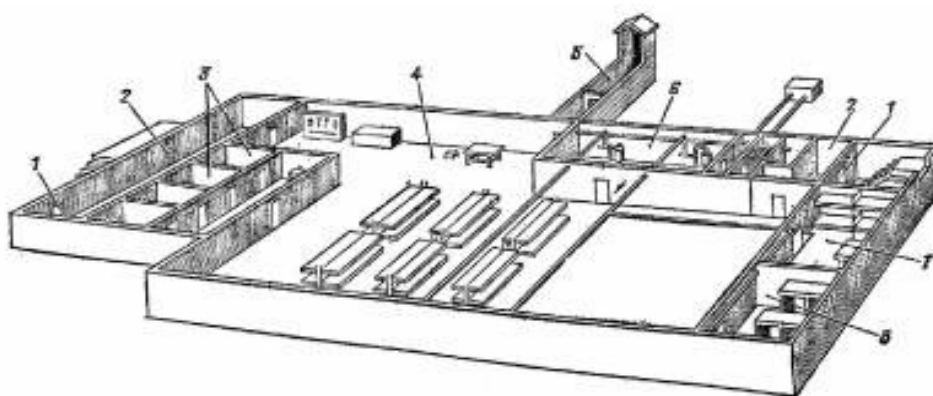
План встроенного убежища: 1 – защитно-герметические двери; 2 – шлюзовые камеры; 3 – санитарный узел; 4 – помещение для отдыха людей; 5 – аварийный выход; 6 – фильтровентиляционная камера; 7 – медпункт; 8 – кладовая для продуктов
